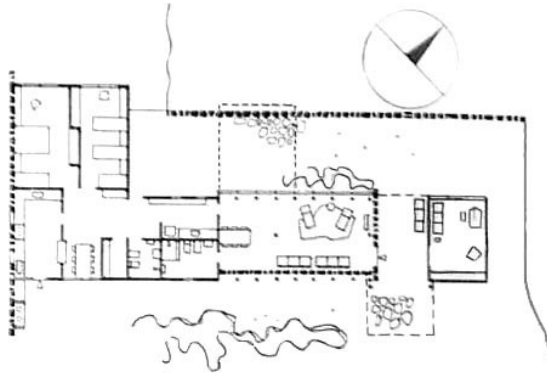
Planta da casa de veraneio. Fonte: CAVALCANTI 2001:78
